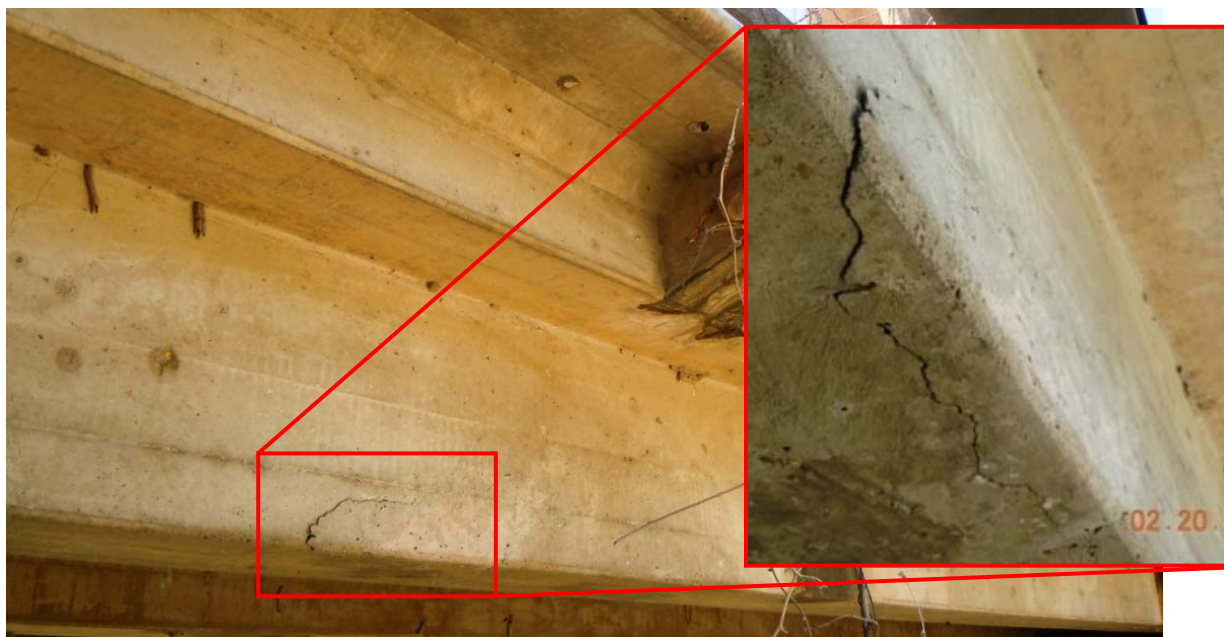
Vista inferior de las grietas por flexión en el centro del claro de las vigas principales.
